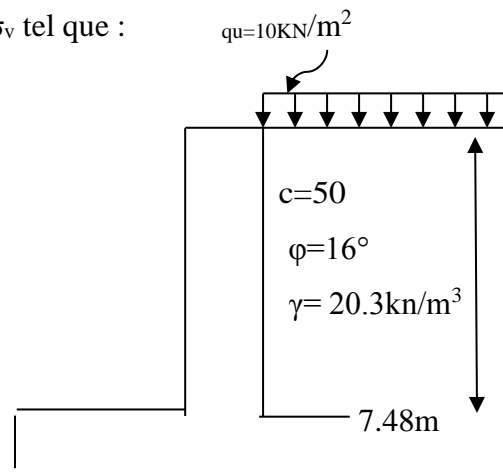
Schéma du mur plaque (Vue en élévation).
